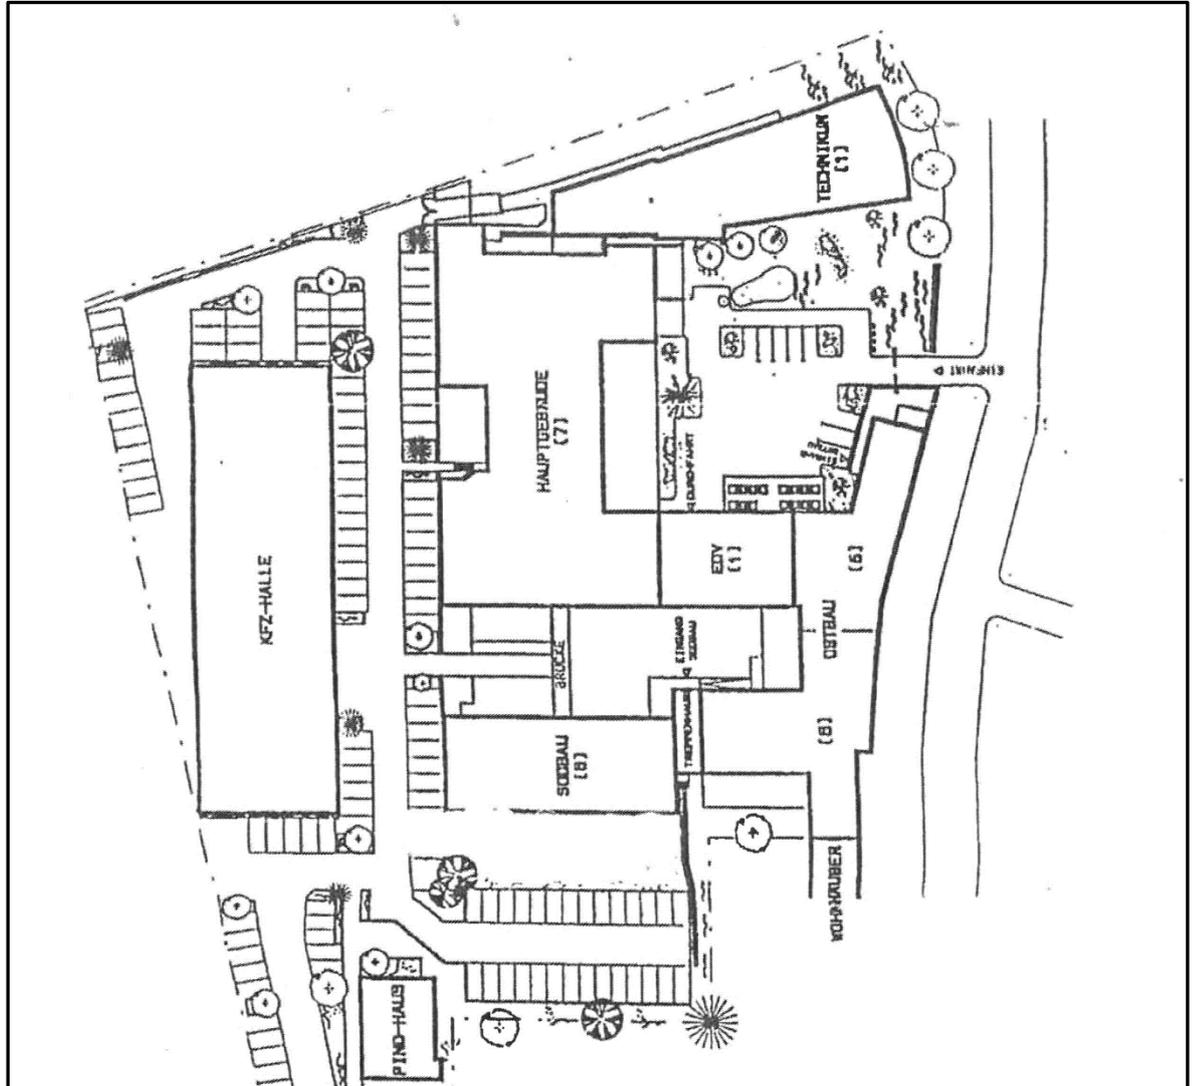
Lageplan des Geländes am Hohenzollerring, gemäß [24].
